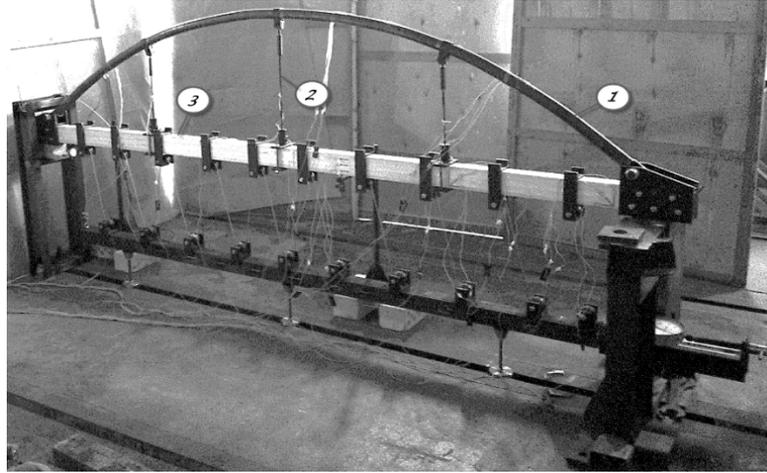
Общий вид стенда для испытаний с установленной арочной конструкцией: 1 – арка; 2 – подвески; 3 – балка
